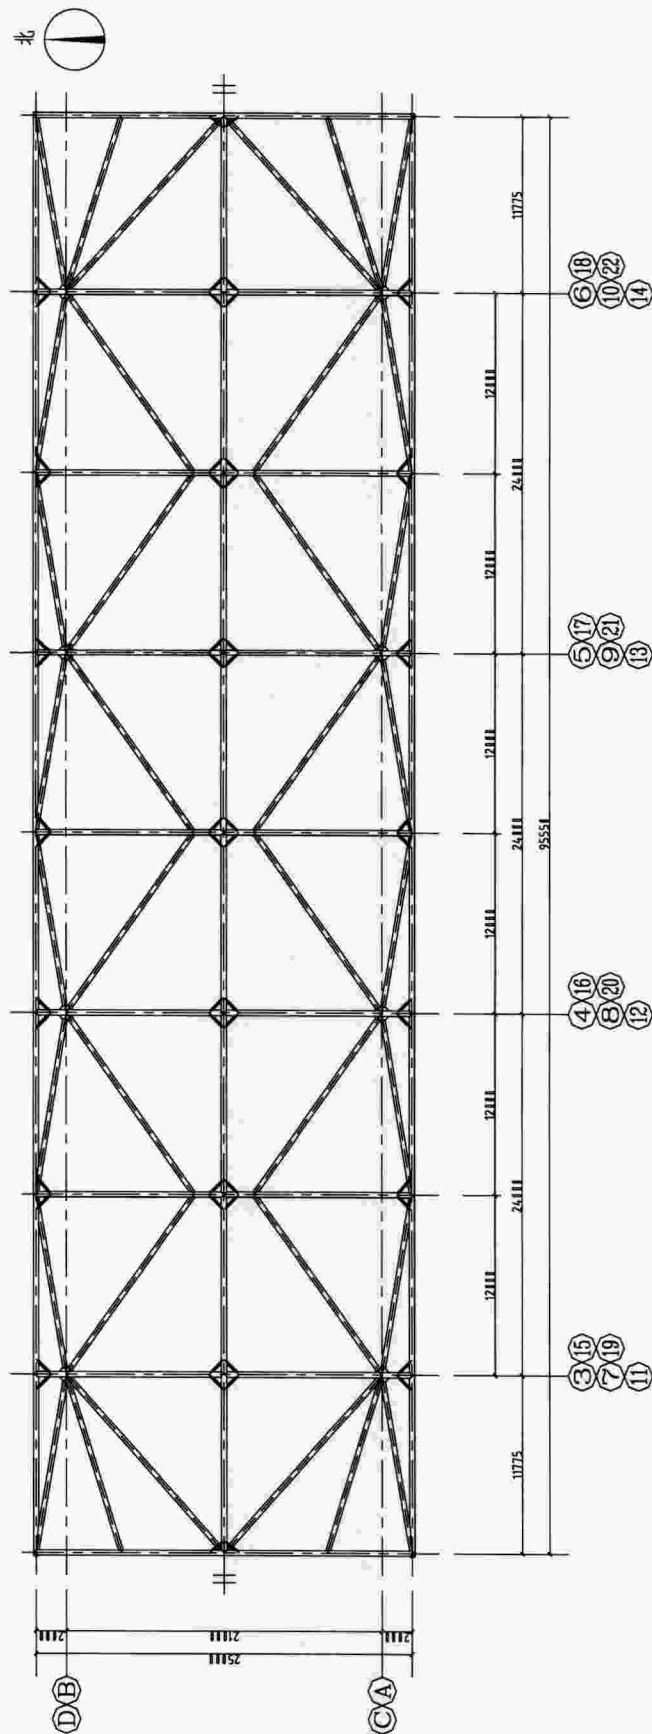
标准单体 B 结构平面布置示意图(单位: mm)
